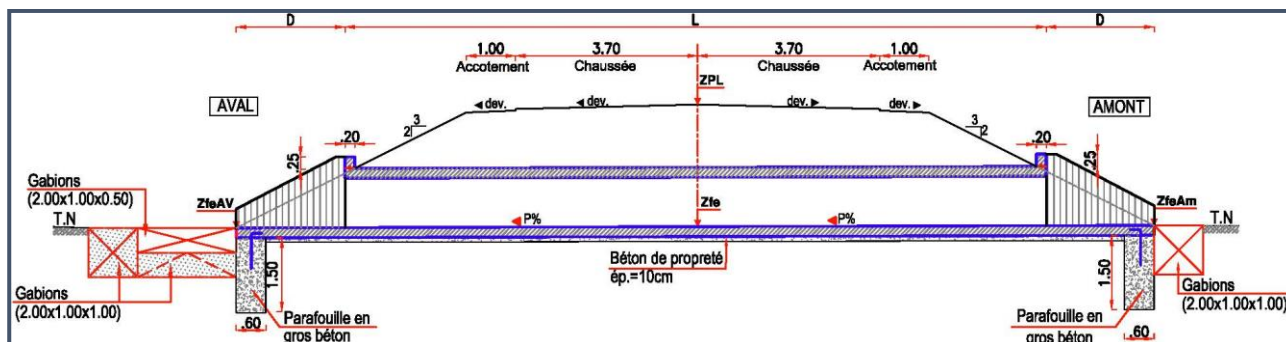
Coupe longitudinale d'un dalot au niveau de la RNT55
